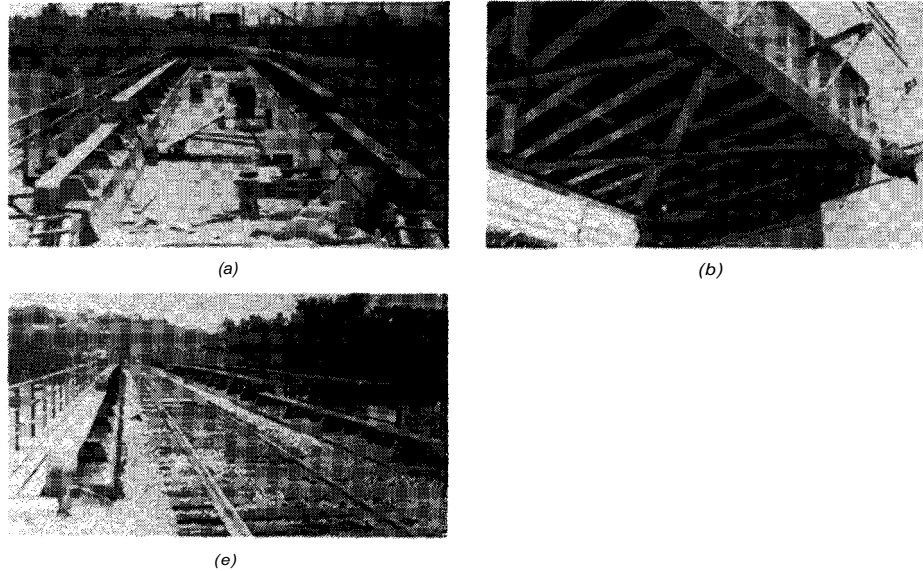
Puente de ferrocarril de tablero superior con traveses y balasto. (a) Puente en construcción de tablero inferior, con traveses y balasto. Nótese que las cartelas para la estabilidad lateral soportan también el patín a compresión a intervalos muy cercanos. Aunque no se ve claramente, las placas del tablero están soldadas a tope y enrasadas en el campo. (b) Vista de la parte inferior del puente de tablero con balasto que se mostró más arriba. Nótese las ménsulas del acotamiento para mantenimiento, en la parte exterior de la trabe, donde se añadirán los tableros de piso. (e) El puente terminado, con el balasto y la viga colocados en su lugar. También está terminado el acotamiento para mantenimiento.
